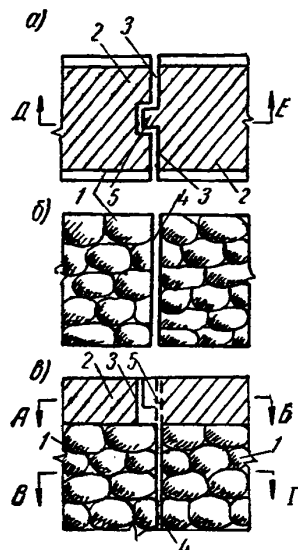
Переход от осадочного шва фундамента к осадочному шву стены
